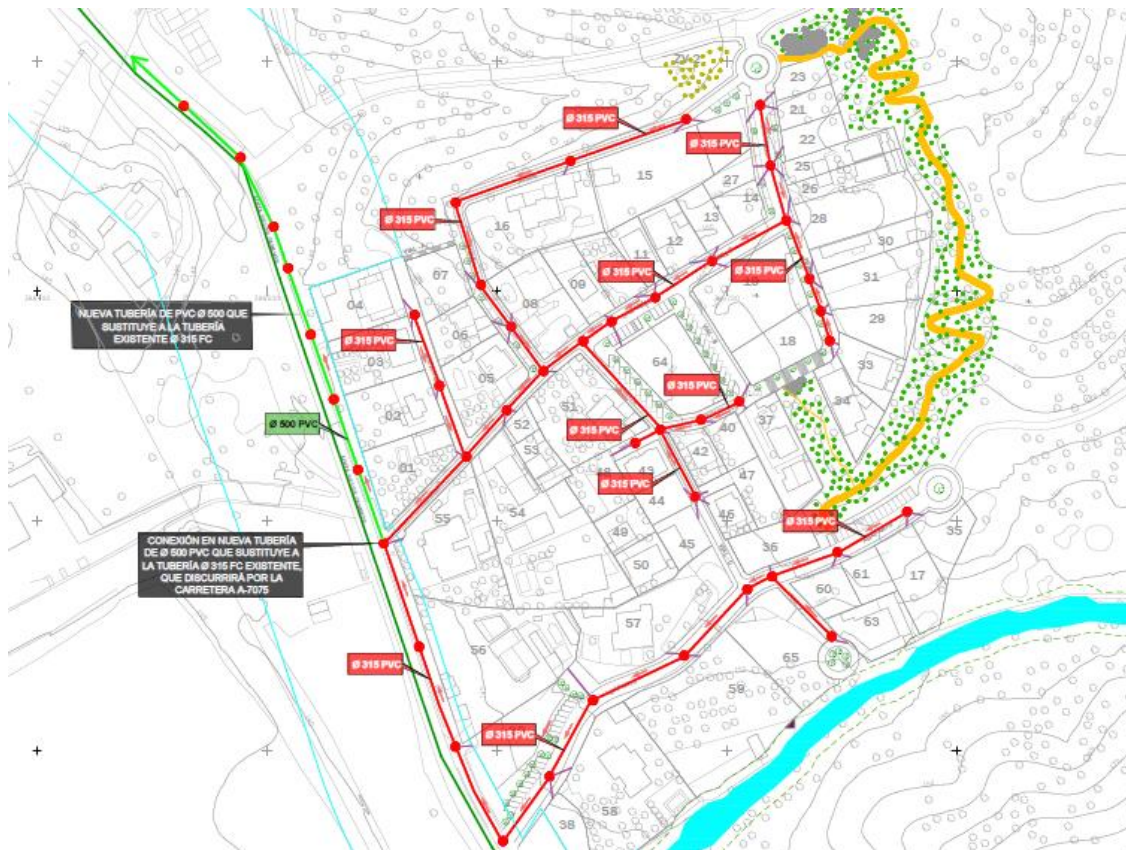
Detalle de la nueva red de saneamiento de aguas fecales y conexión con la red existente.
